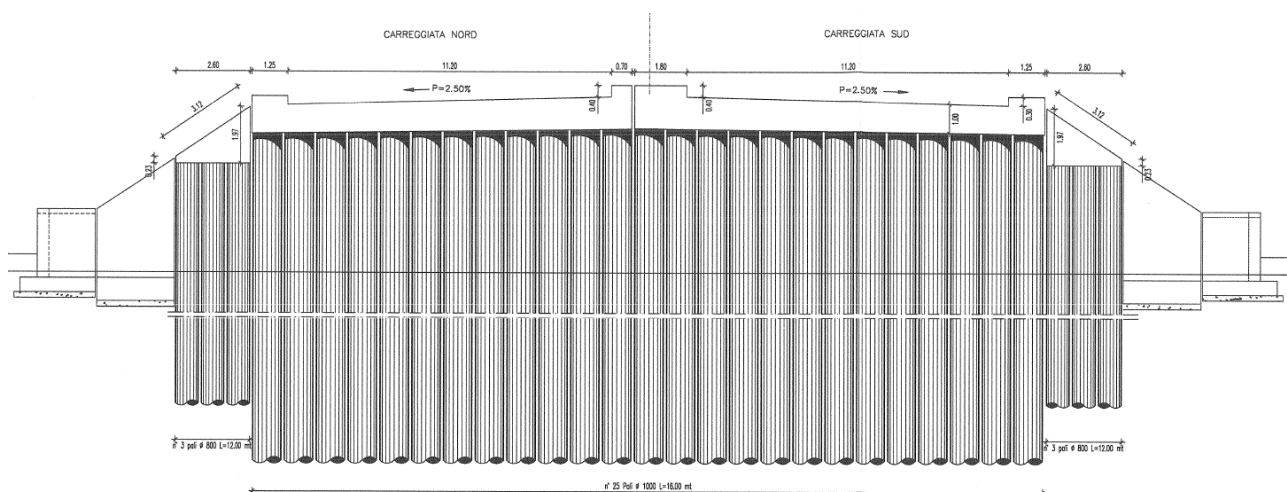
Estratto del progetto originale – profilo longitudinale dell'opera
